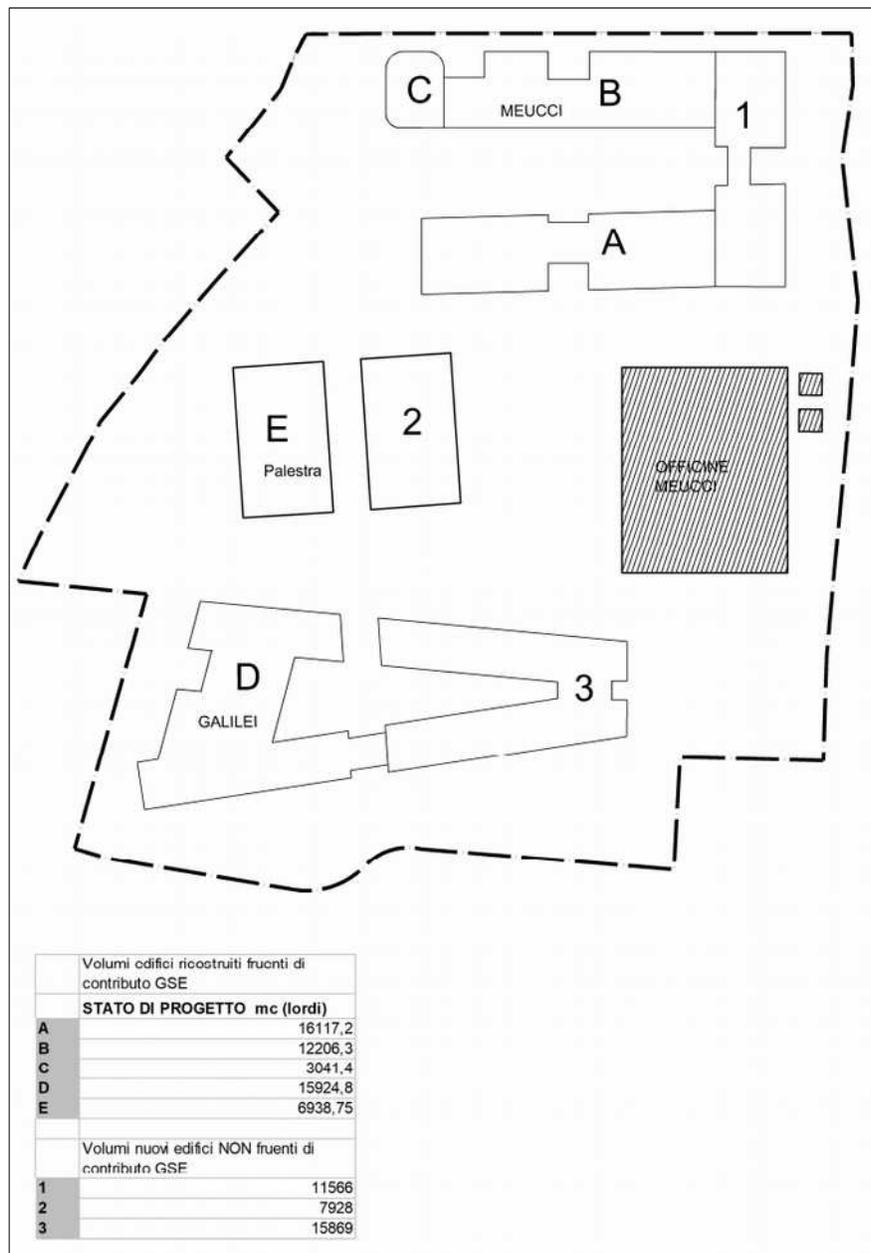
Schema stato di progetto con individuazione edifici da costruire
